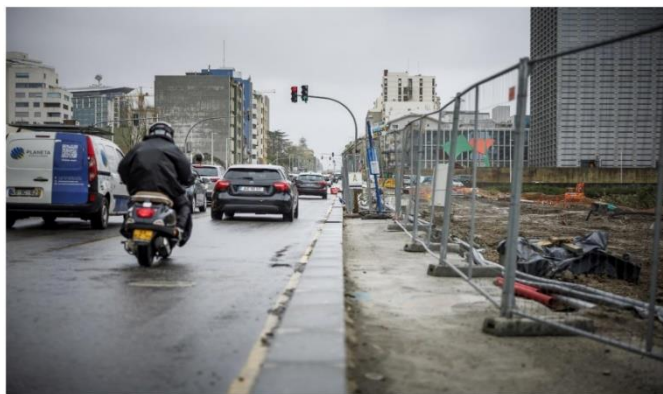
Paragem de autocarro provisória na Avenida da Boavista (28 março 2024).
